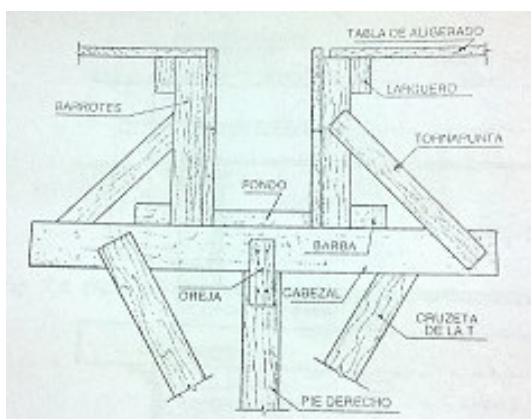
Tornapunta en el encofrado de vigas (PACHECO 2001)
